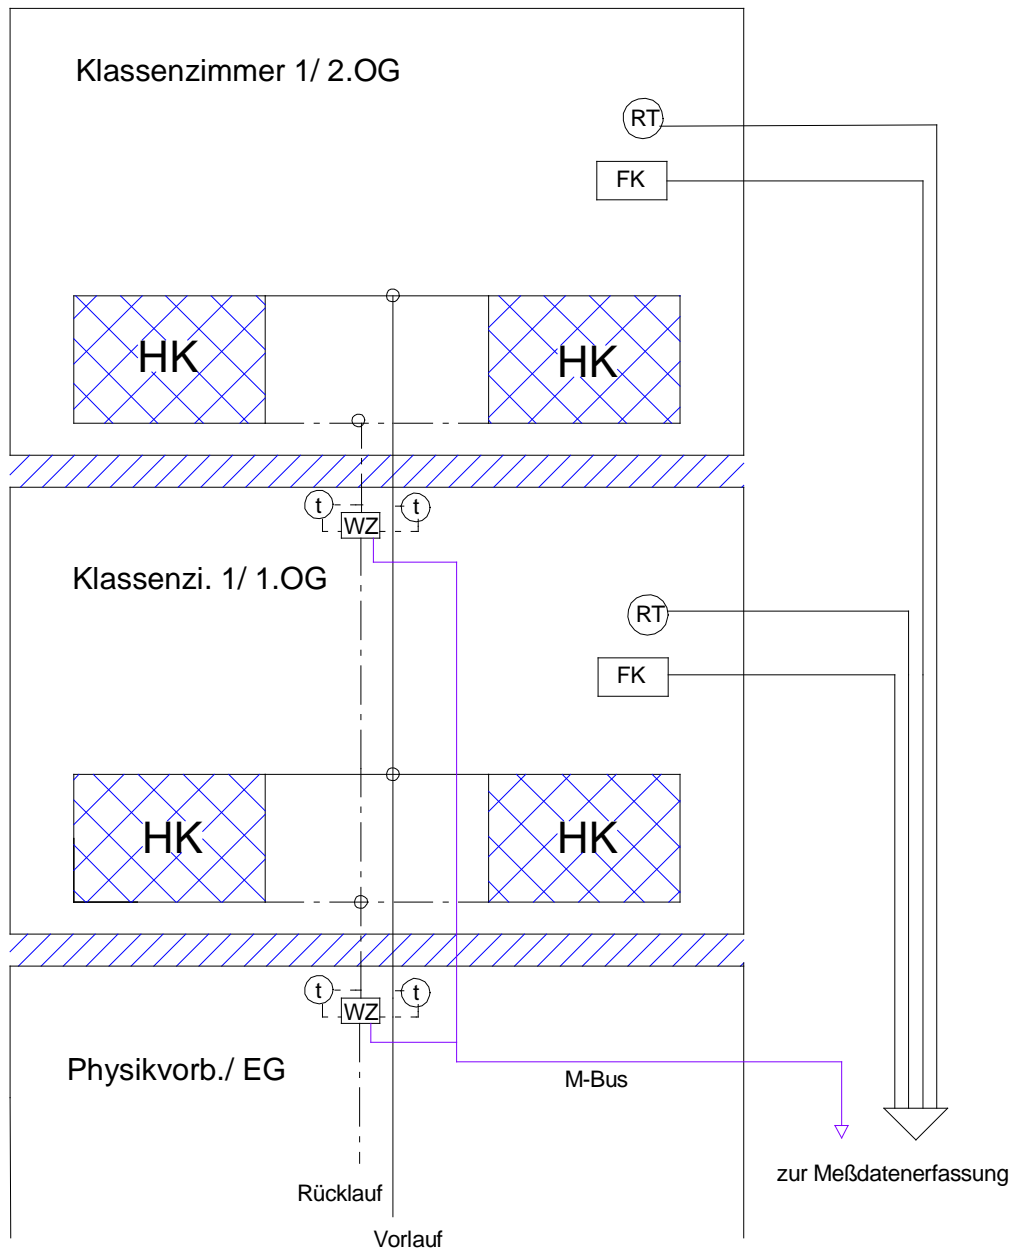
Detailbetrachtung der Einbauorte der Wärmezähler in Bauteil 3
